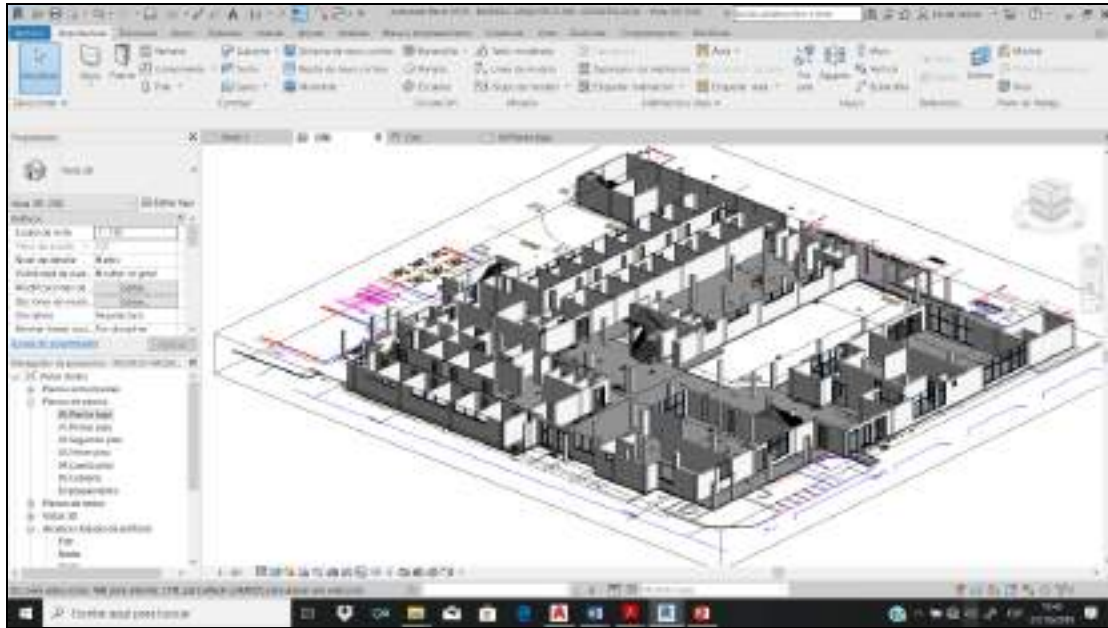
Autodesk Revit - Vista 3D, Colocado de muros, puertas, ventanas (Planta Baja)
